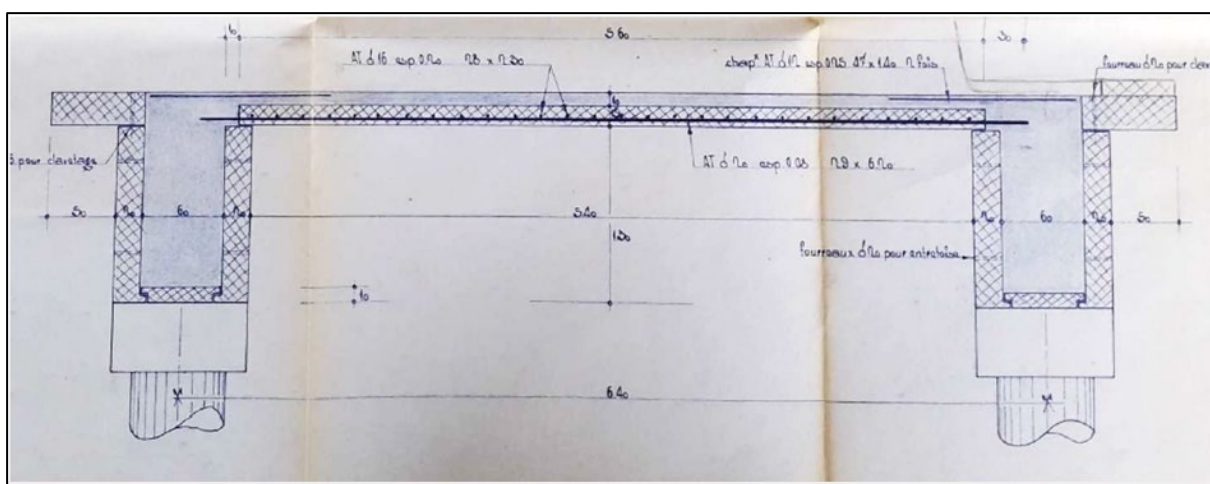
Plan de coffrage/ferrailage du tablier (source : capitainerie)
